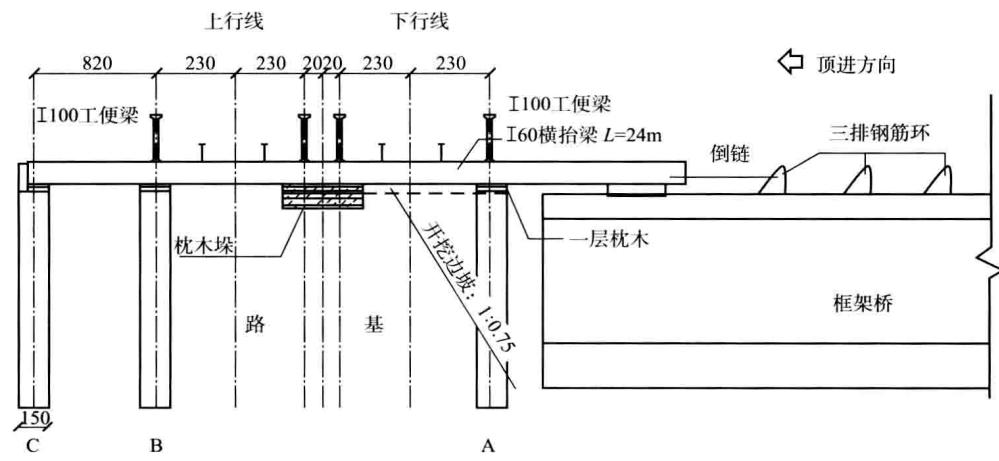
商周二期下穿陇海铁路箱桥架空顶进横断面图(尺寸单位:cm)
